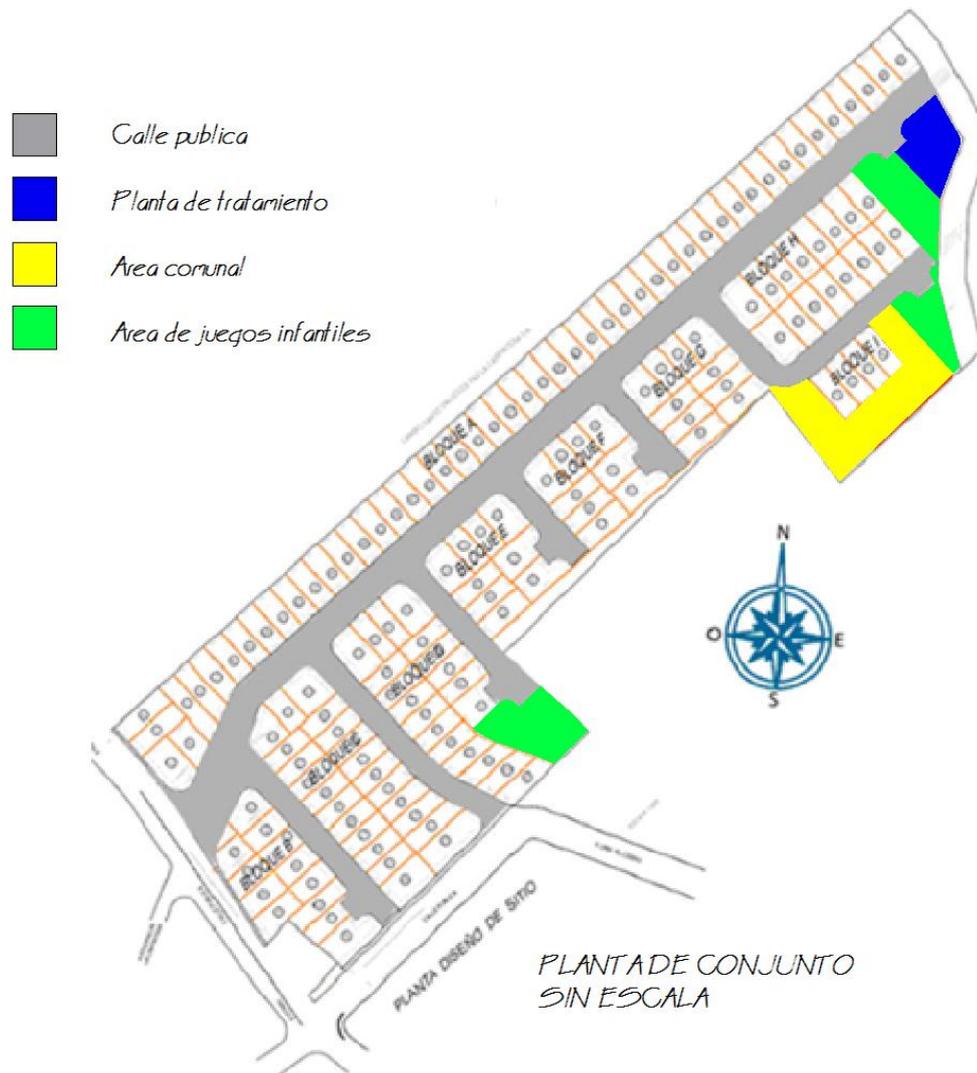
Ubicación de la planta de tratamiento en el proyecto residencial
